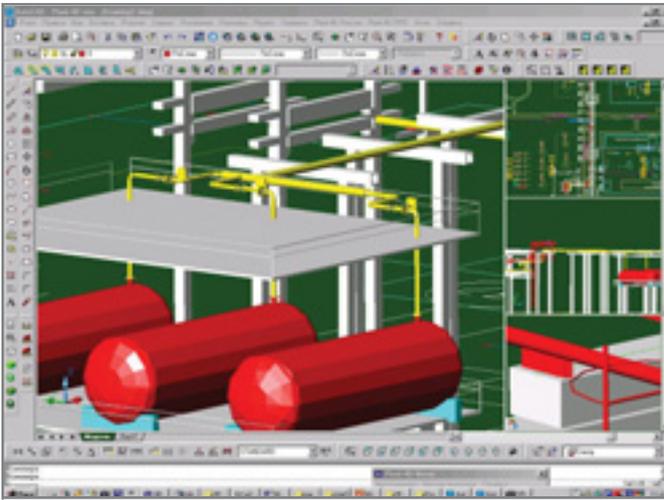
Совместная работа модулей PLANT-4D Трубопроводы и PLANT-4D Оборудование и металлоконструкции
